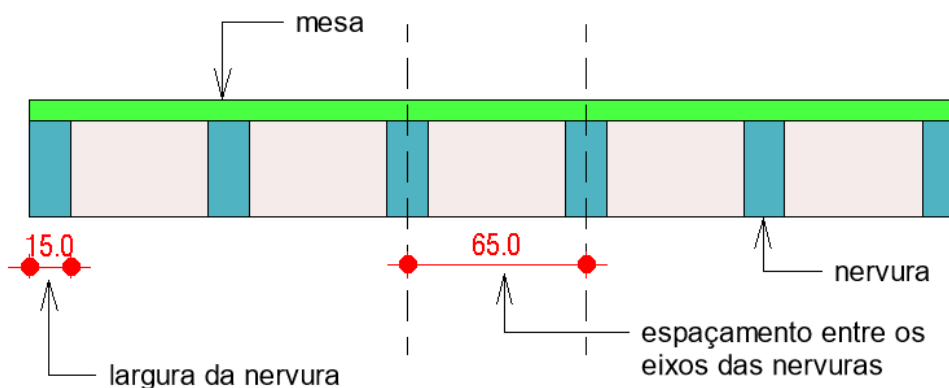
Vista frontal da laje nervurada lisa bidirecional - espessura da mesa
